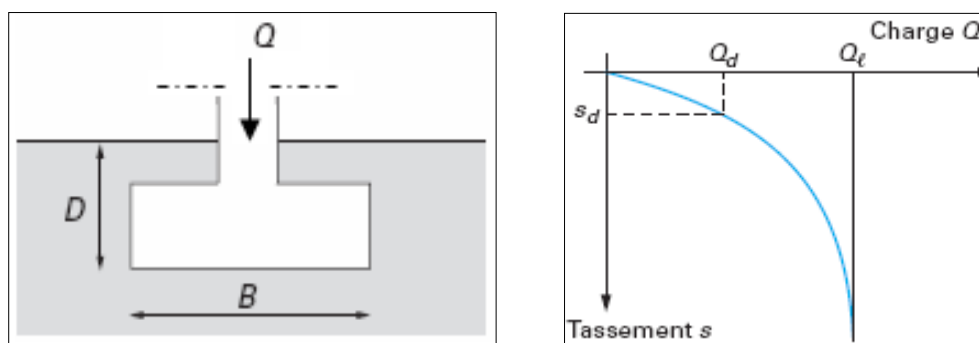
Courbe chargement-tassement d'une fondation superficielle
